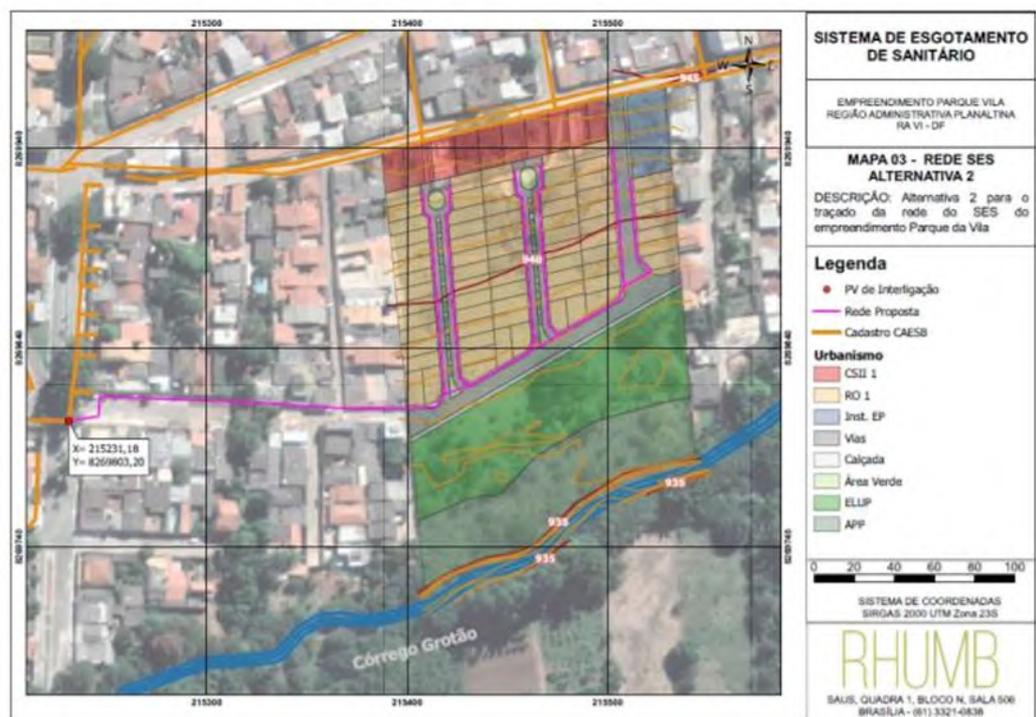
Traçado da rede previsto para escoamento sanitário (Fonte MDE-EP)
